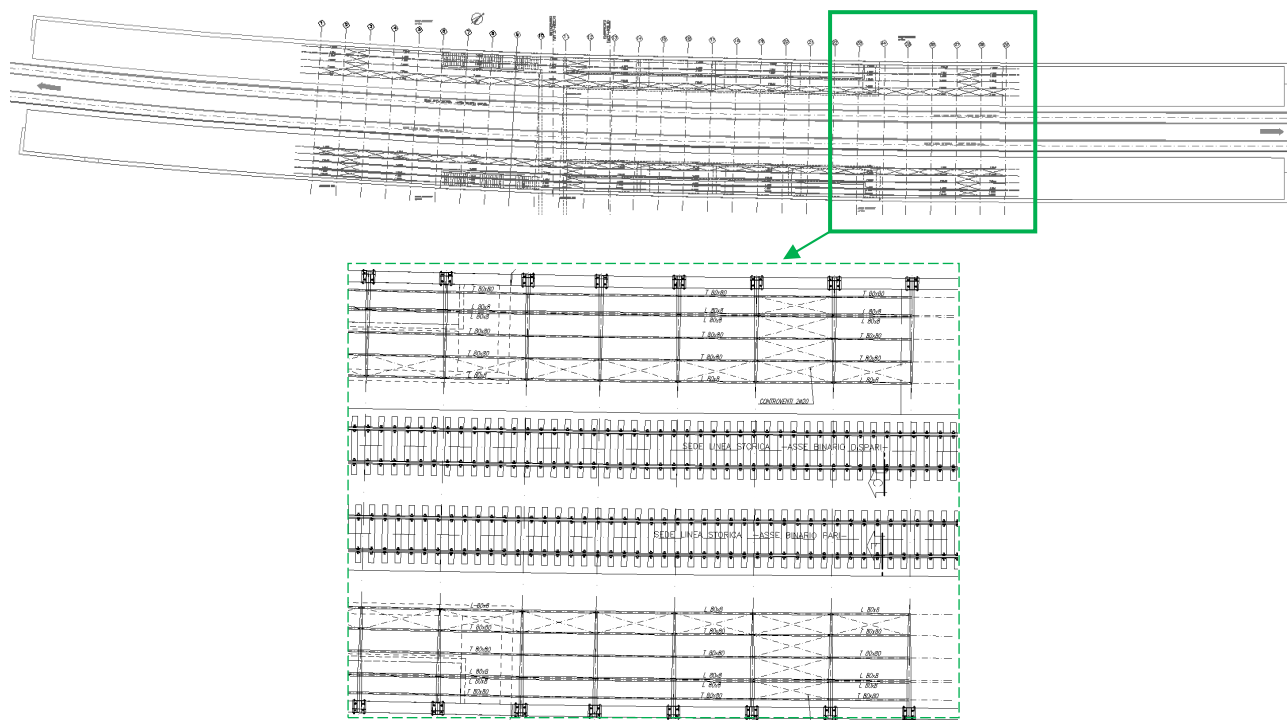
Planimetria generale dell'intervento e dettaglio pensilina
